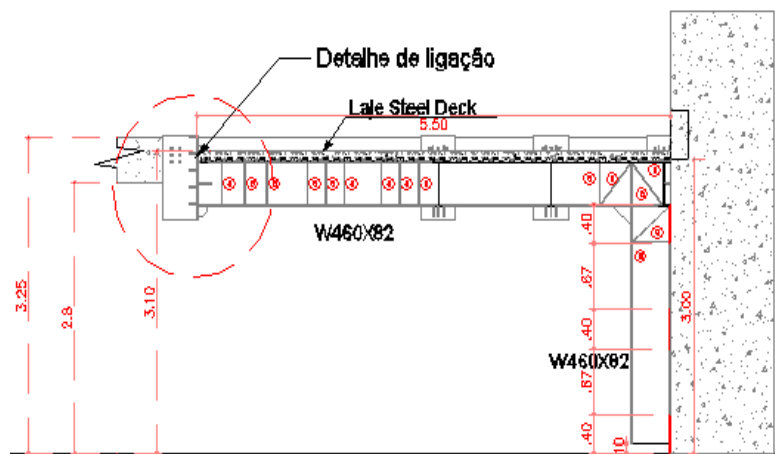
Ligação entre viga do mezanino 2 com de concreto.
